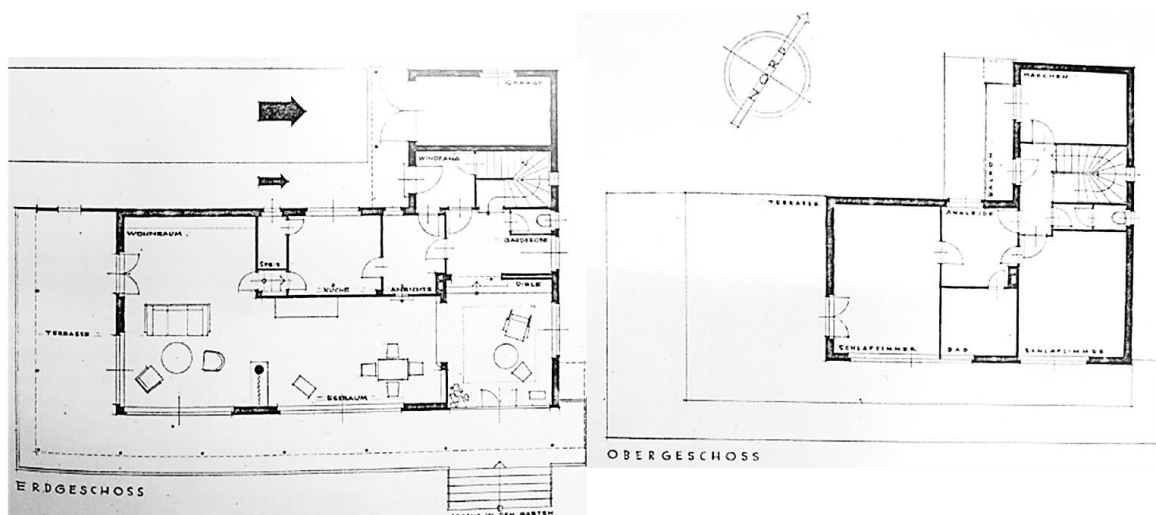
Grundrisse des EG (links) und OG (rechts) [50]
